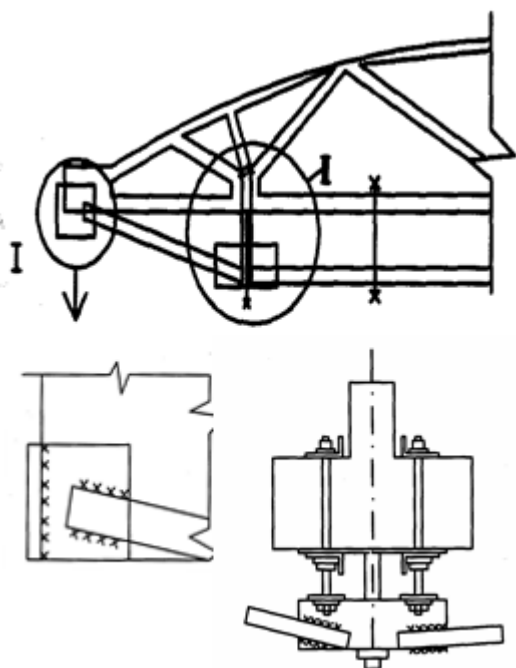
Конструктивная схема усиления стропильной железобетонной фермы стальными шпренгельными затяжками с созданием в них натяжения распорными усилиями
